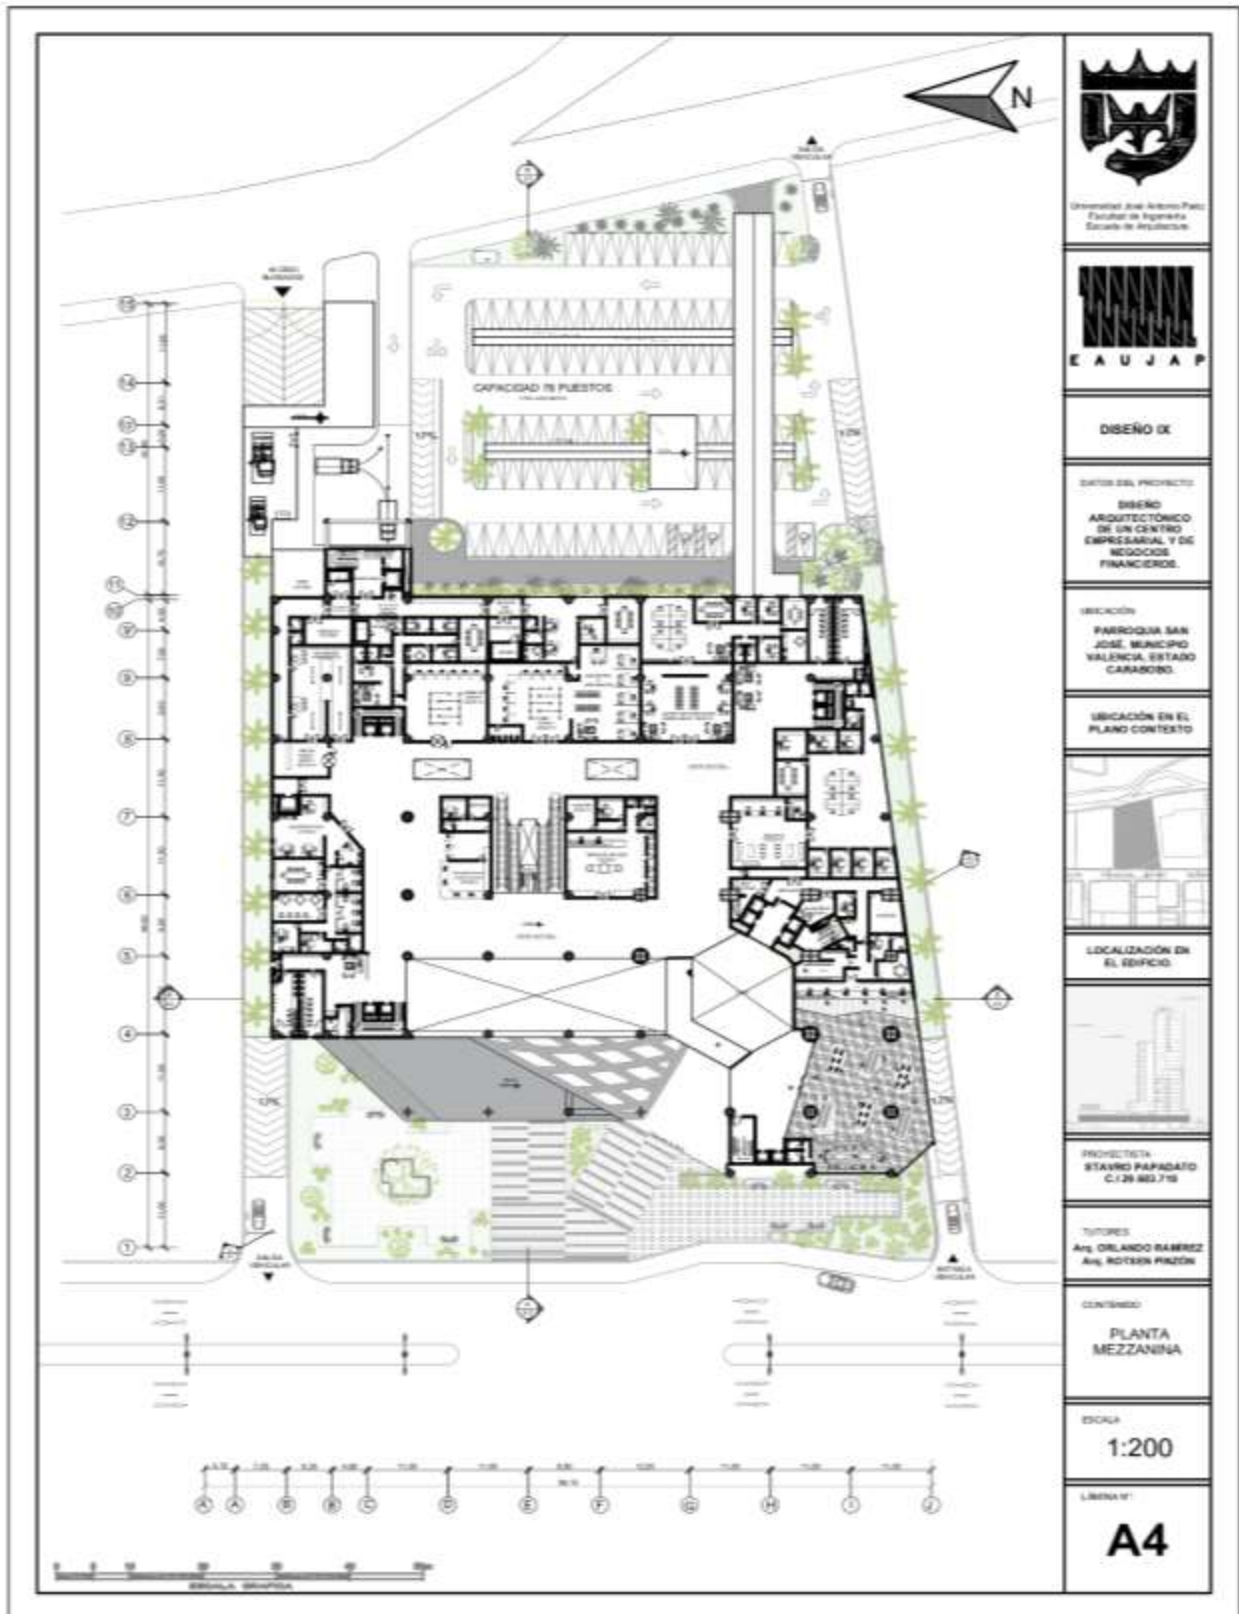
A – 4 Planta Mezzanina Fuente: El Autor (2023)
